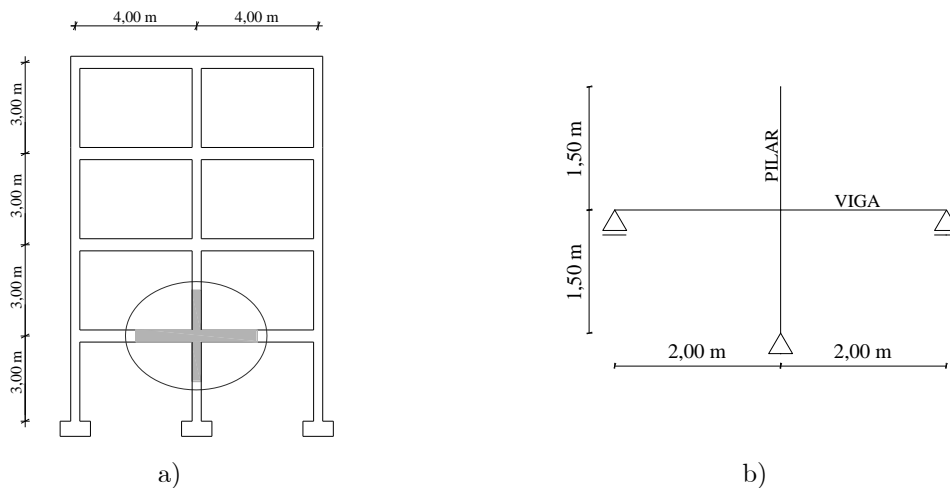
a) Nós viga-pilar em estudo; b) Esquema estrutural e condições de apoio idealizadas para o ensaio.
